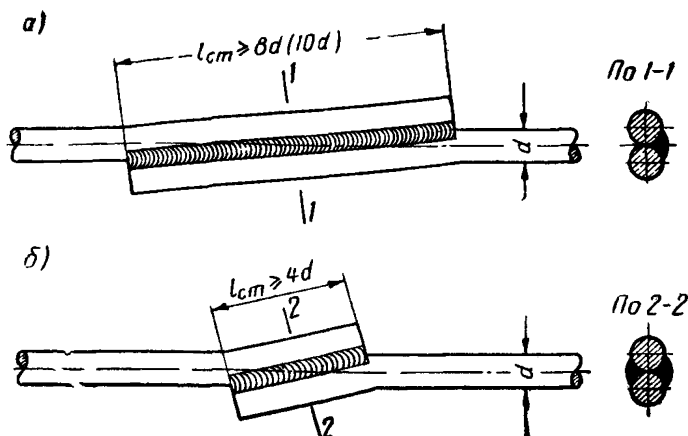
Стыки стержней электродуговой сваркой внахлестку
